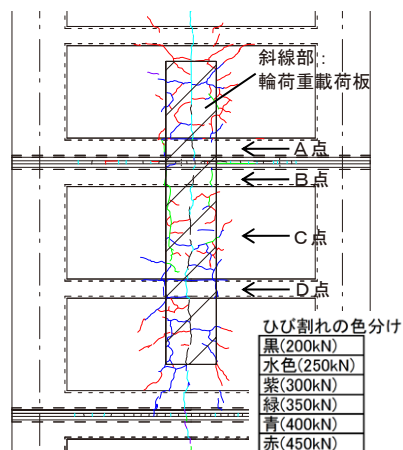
ひび割れ発生状況 (累計載荷 54 万回時)
